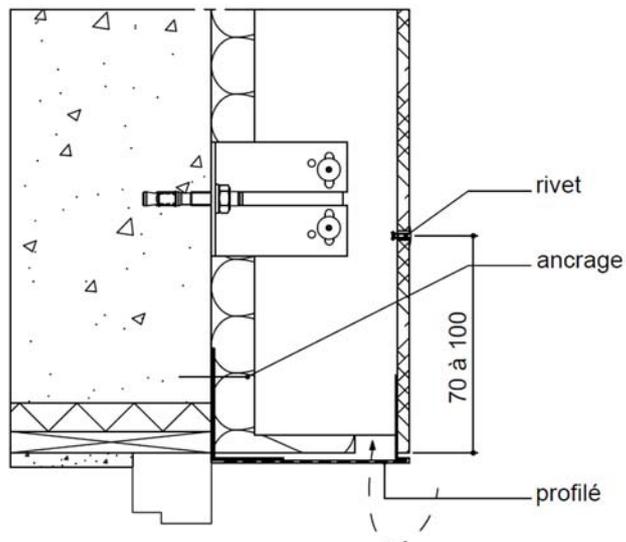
Détail linteau sur ossature métallique (cote en mm)
